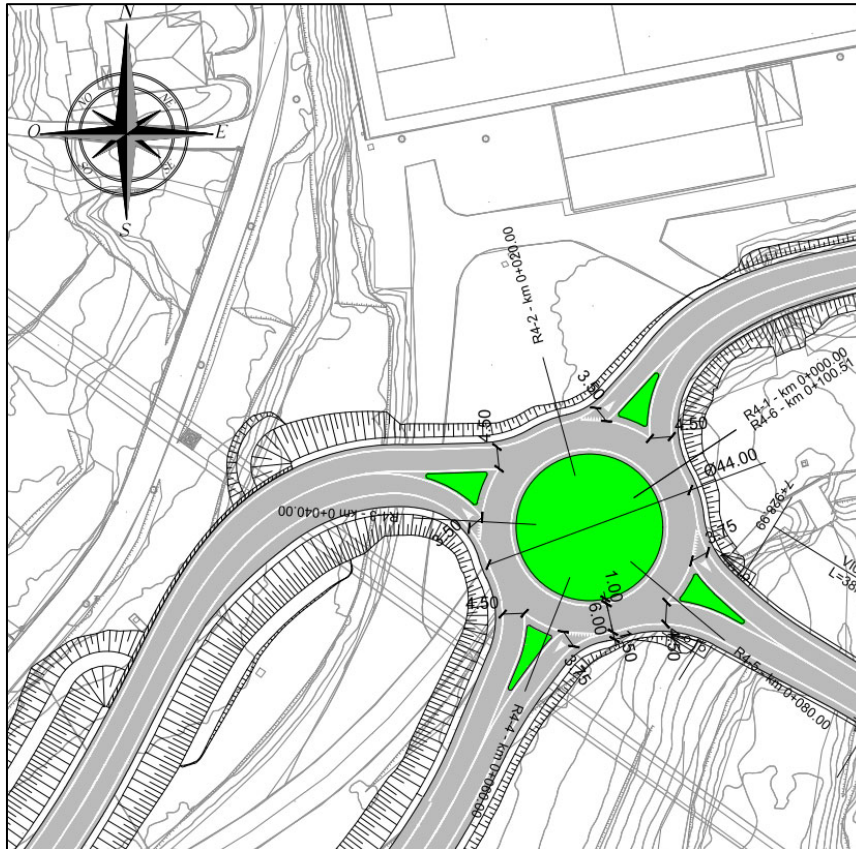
Estratto della planimetria di progetto della rotatoria 4
